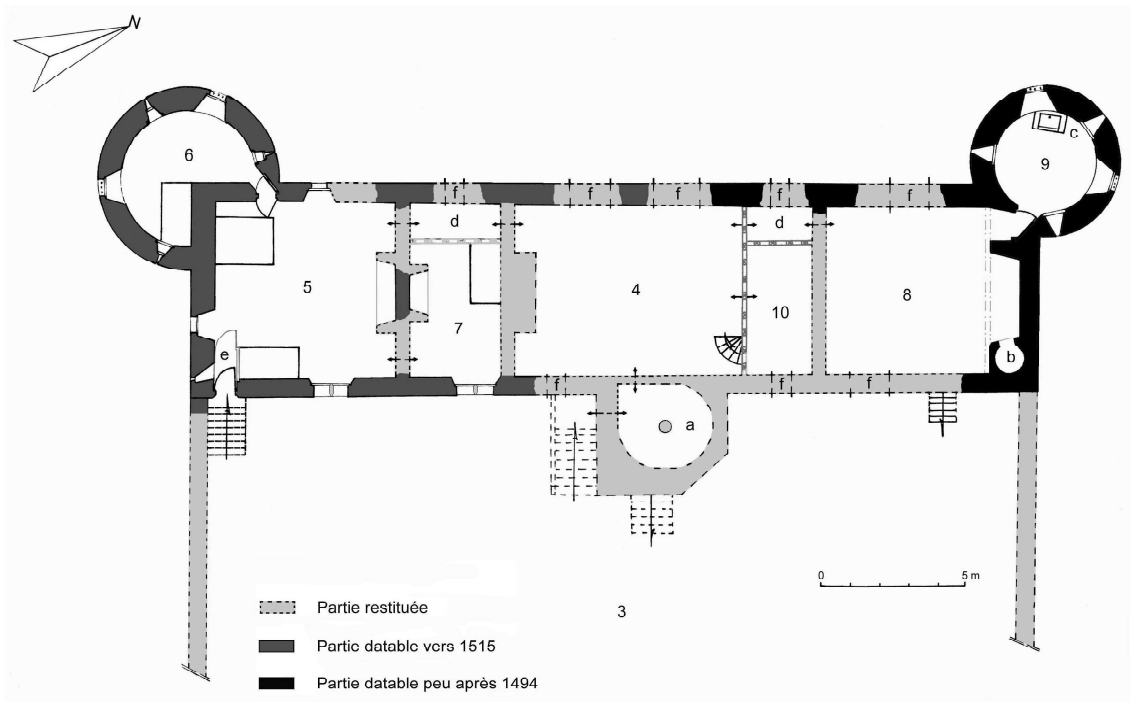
Houlbec. Plan restitué du rez-de-chaussée en 1603 (voir : Volume III, Document n° 21).
